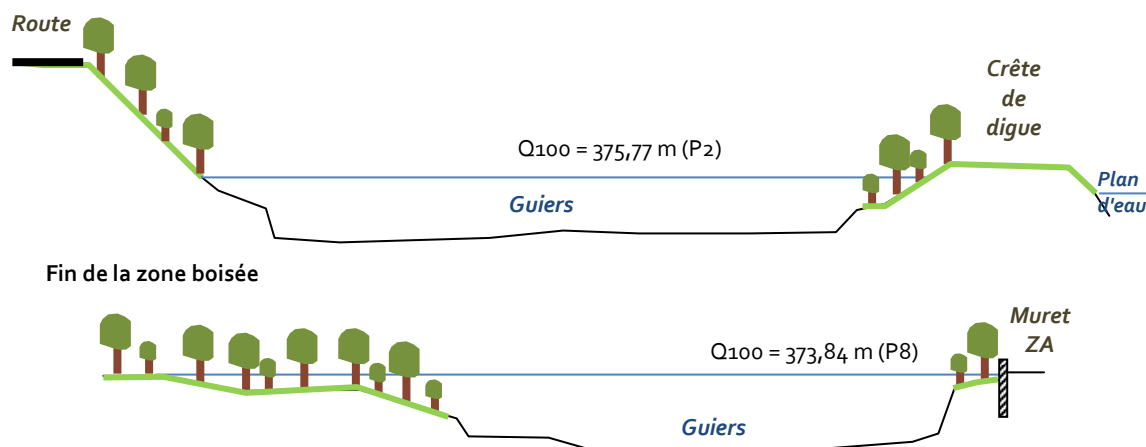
Profil en travers pour Q100 au niveau du plan d'eau (P2) et de la ZA de Hauterives (P8)
